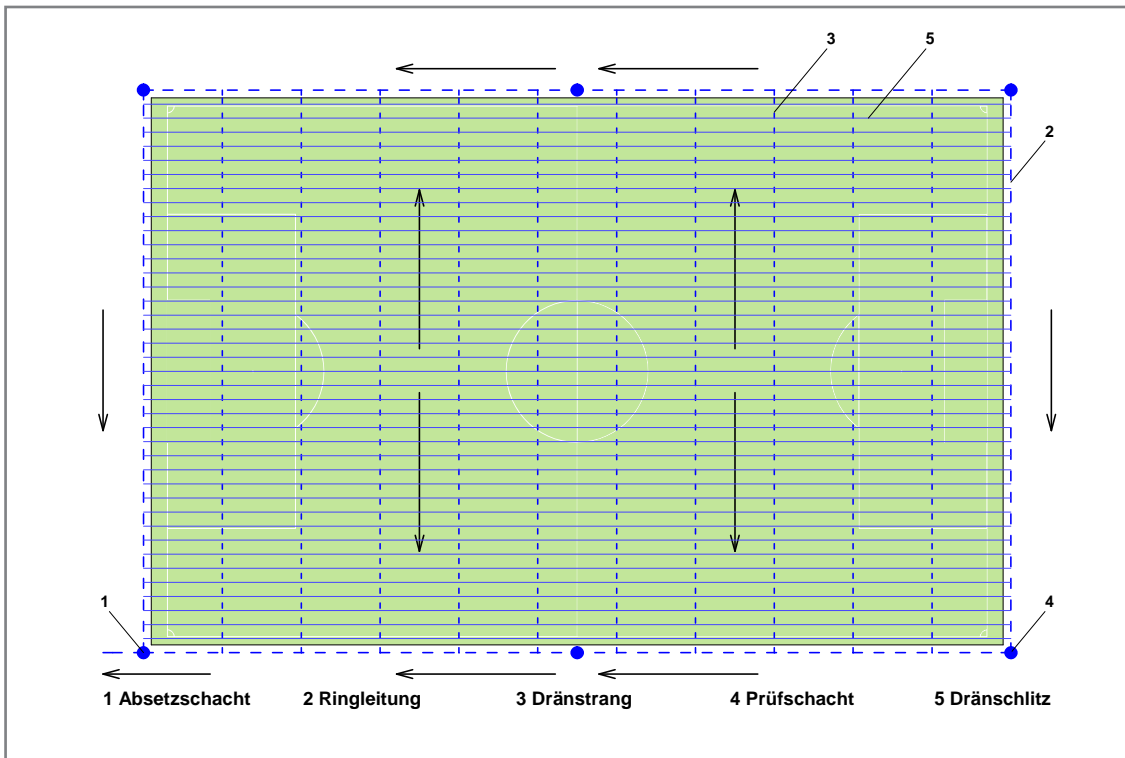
Lageplan, Kombinierte Schlitz-Dränentwässerung für Aufbaubeispiel 3.
